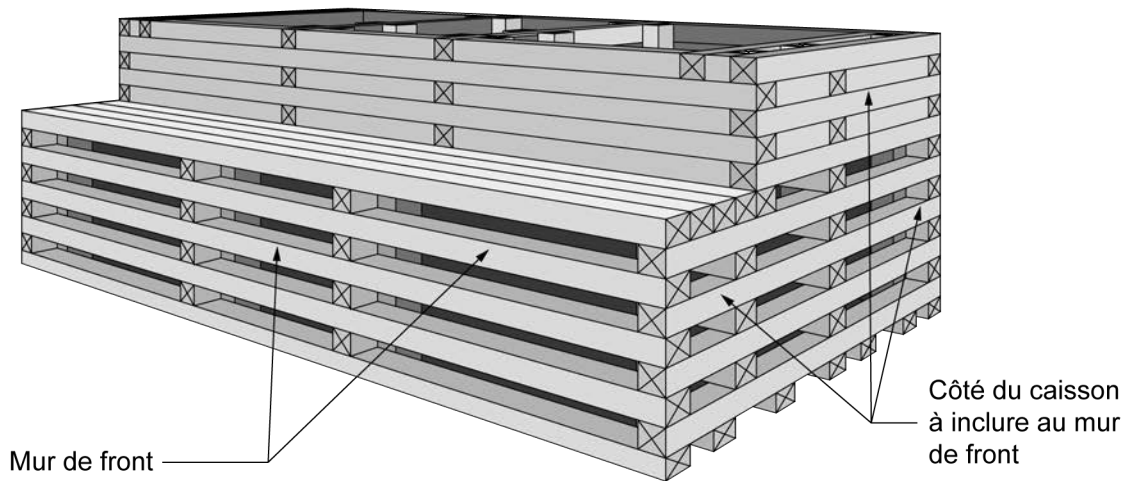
Mur de front d'une culée caisson à claire-voie
